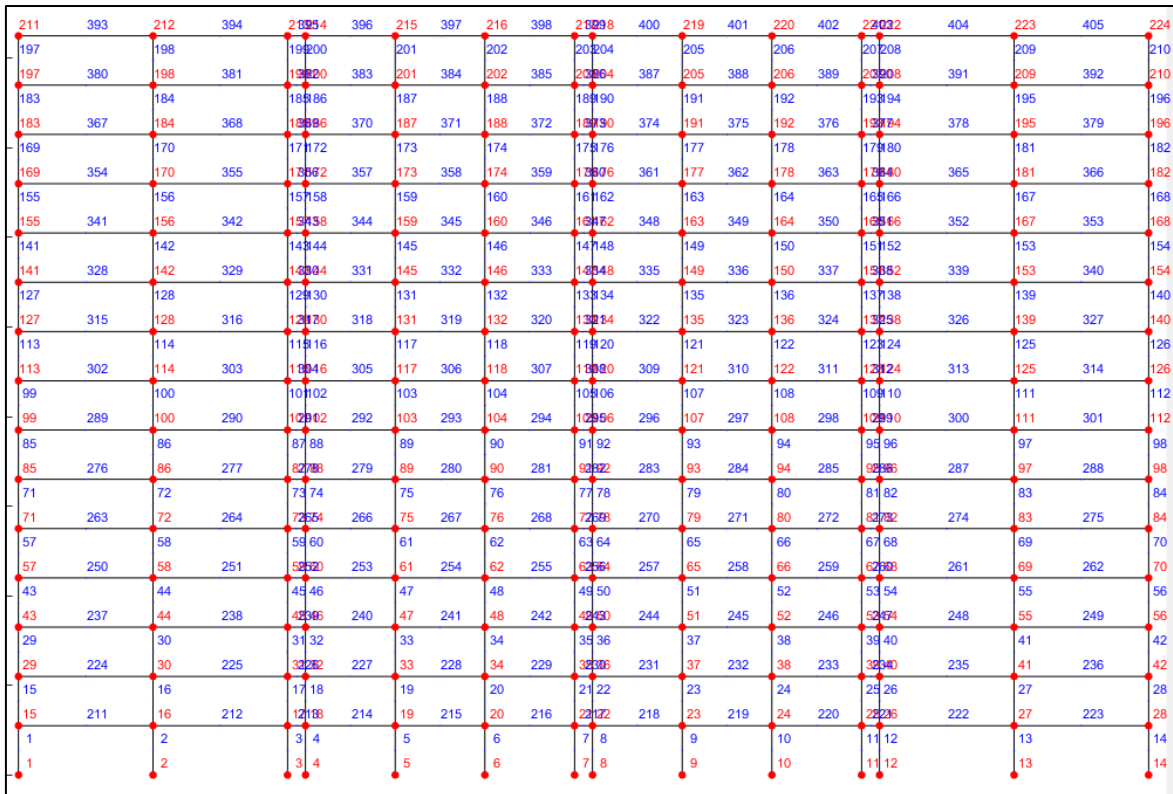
Modelo plano de la edificación de 15 pisos con muros estructurales.
